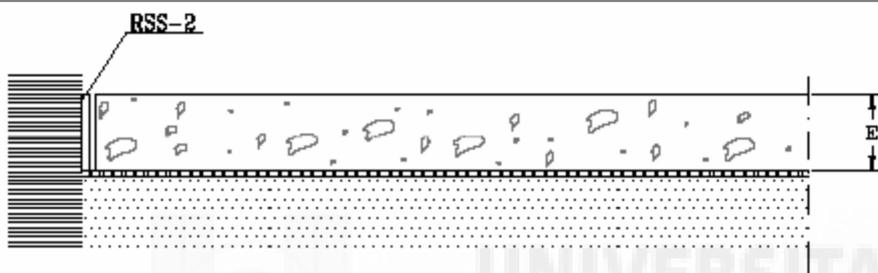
Detalle de las juntas de aislamiento con pilares
